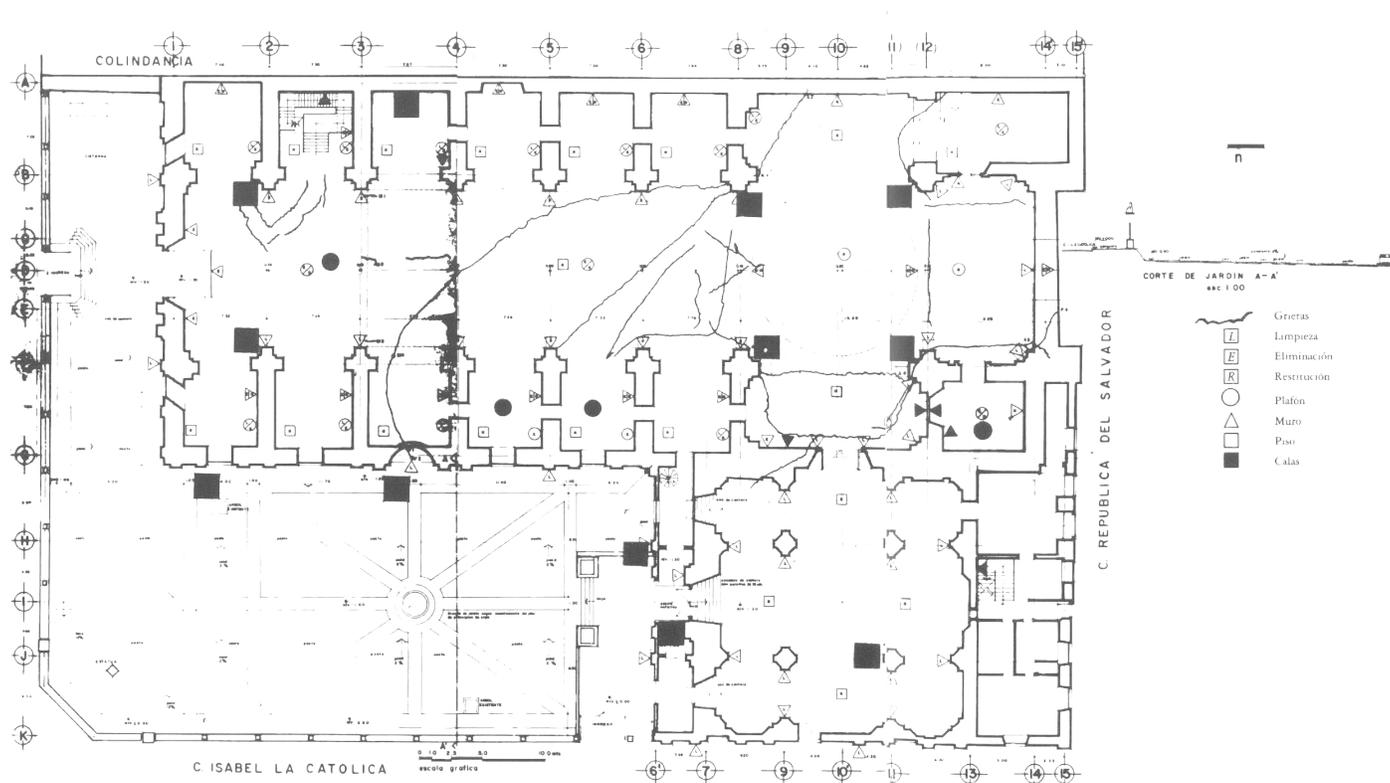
Estado físico de la planta baja del edificio al iniciarse las obras. Levantamiento arquitectónico.
